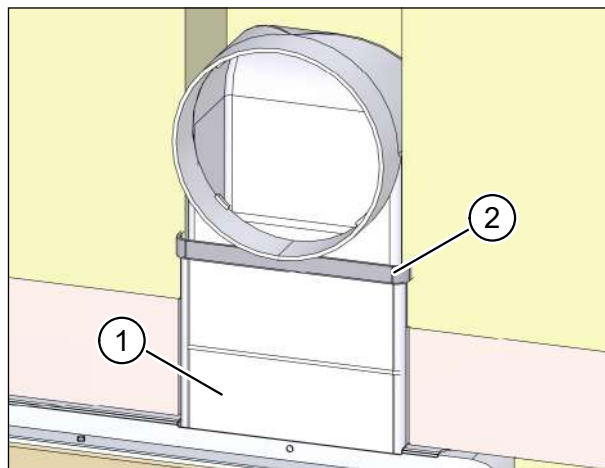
Fissaggio degli allacciamenti del canale piatto con nastro sigillante
